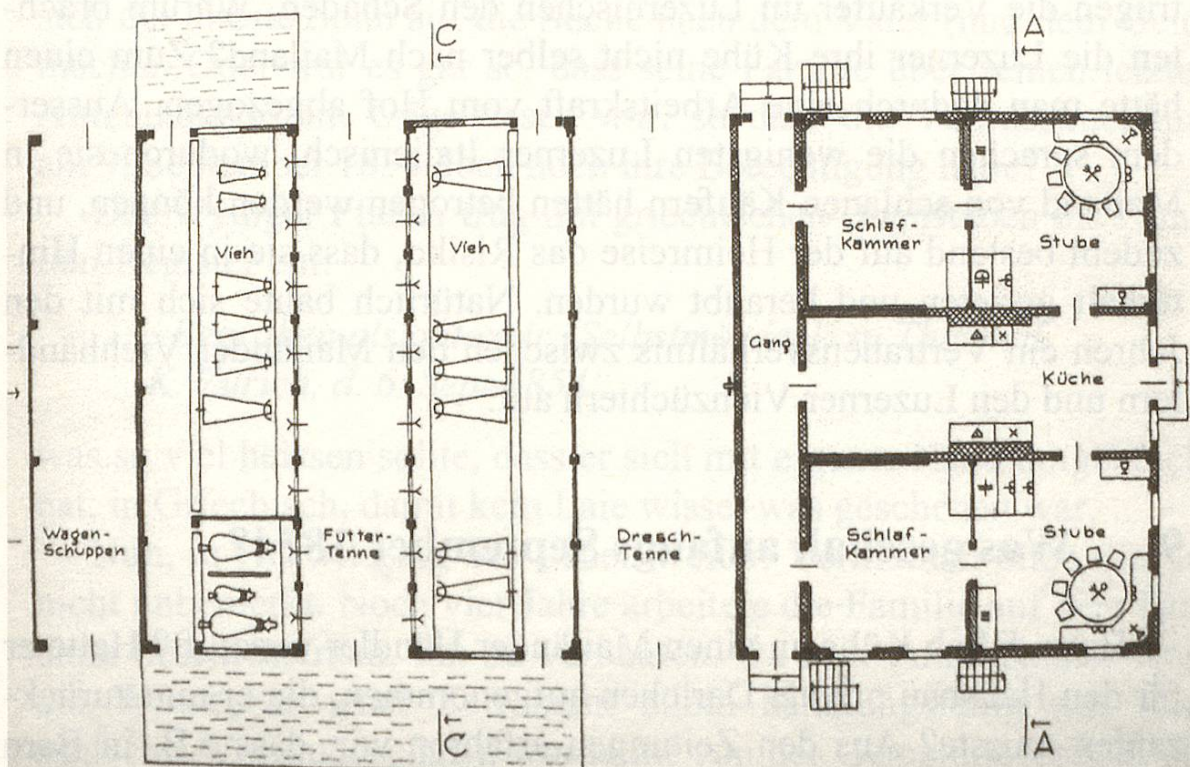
Hüswil: Grundriss, aus "Luzerner Bauernhäuser", 1977
